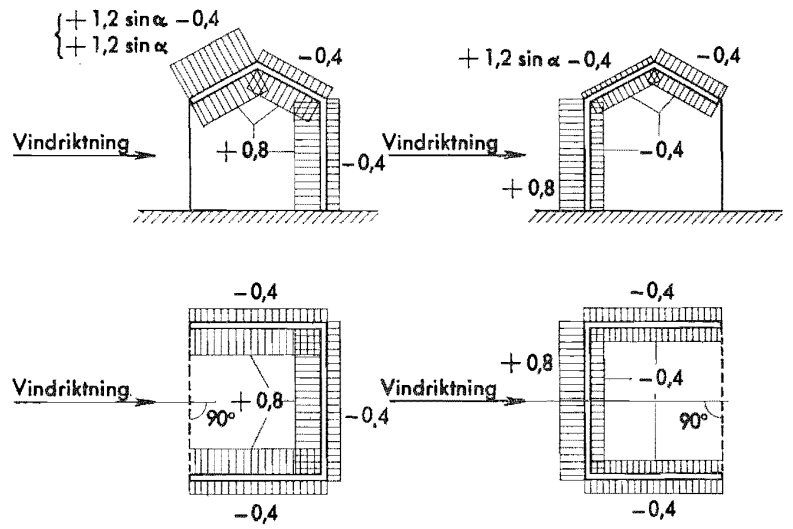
8 a. Byggnad öppen på en sida (överst sektion, underst plan).
